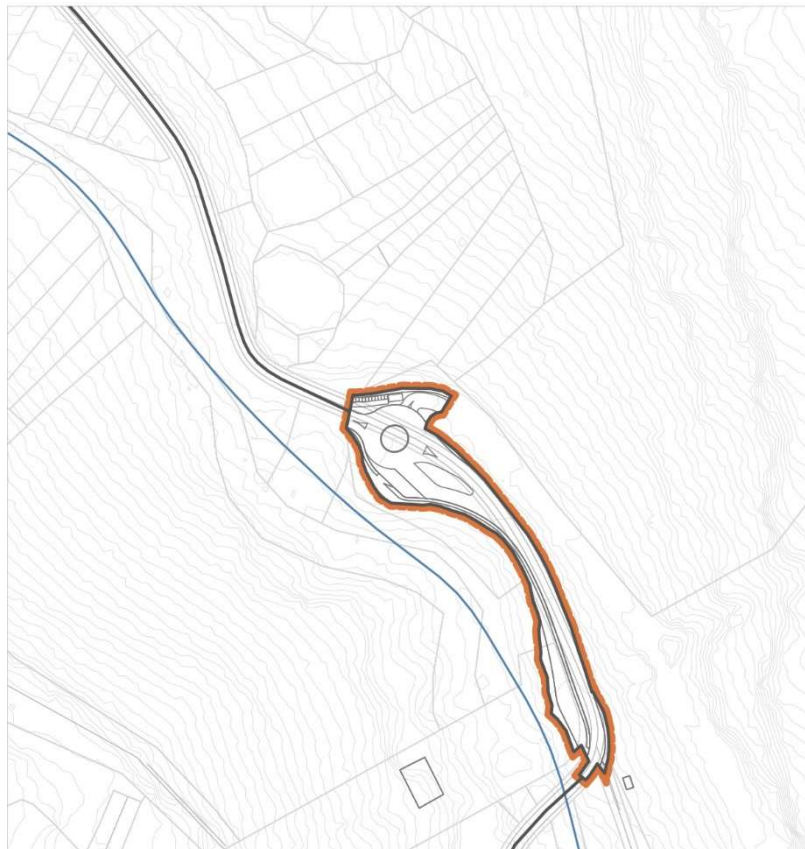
Detalle de rotonda en ámbito norte o tramo 2 (alternativas 1 y 2).
